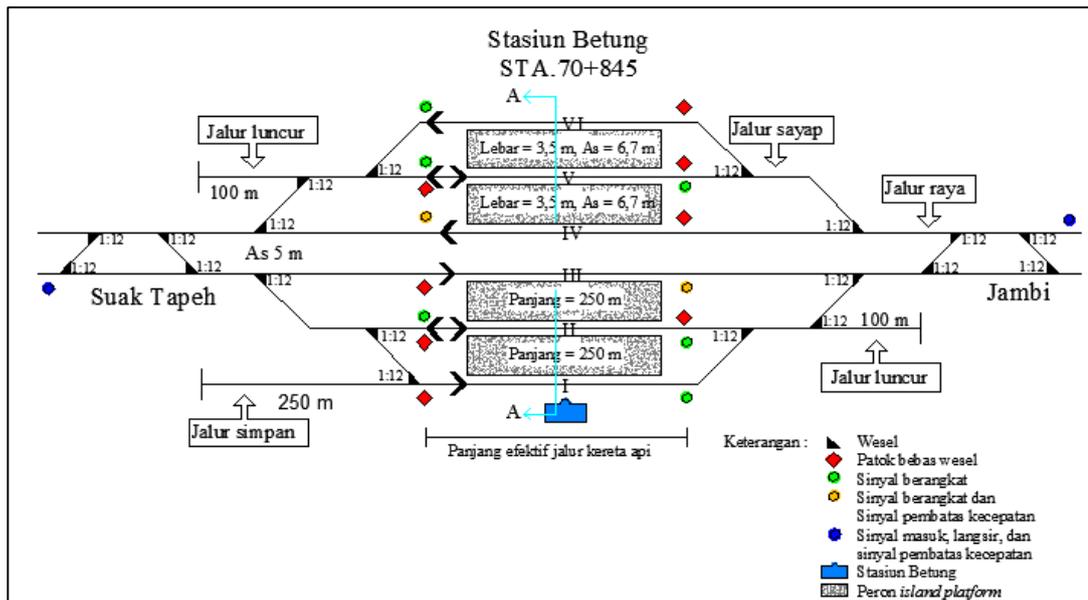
11 Layout Stasiun Betung berdasarkan panjang total jalur kereta api
